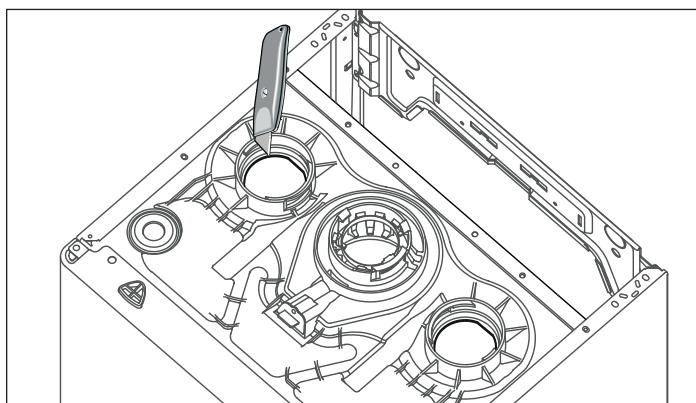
Coupe du plastique recouvrant le raccord du conduit d'entrée d'air
